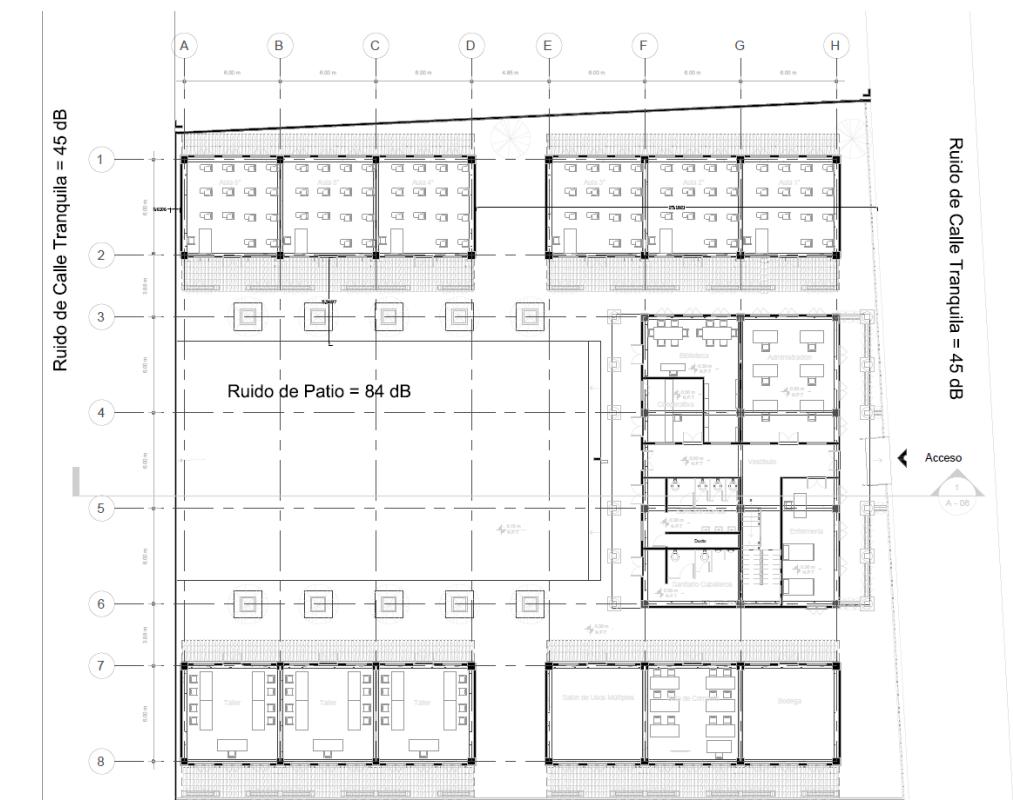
Planta Baja de Todo el Proyecto con Niveles de Ruido Exterior y su Distancia al Receptor.
